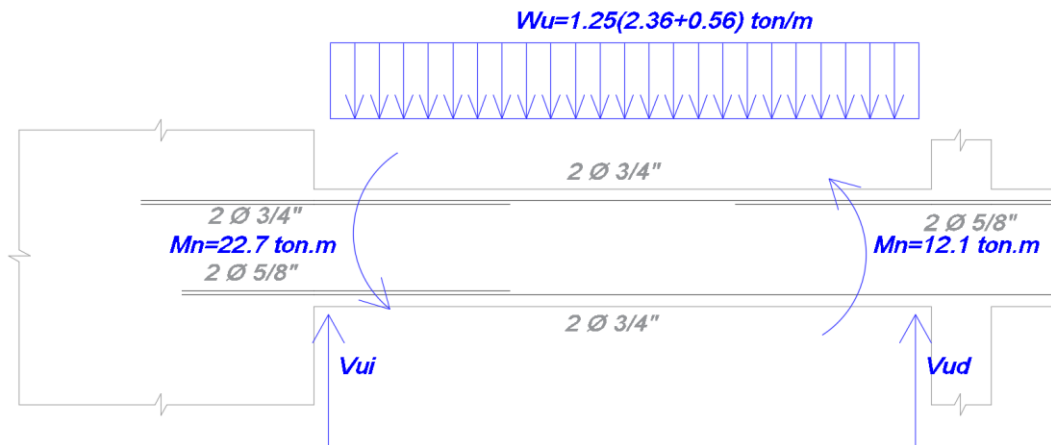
Tramo 1 de Viga V-101 con cargas y momentos para diseño (Caso 1).
